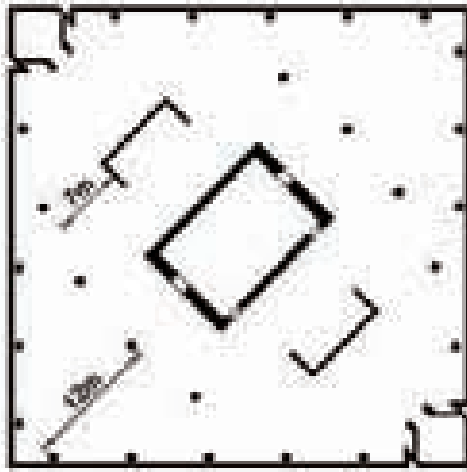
Esquema con la disposición de apoyos y huecos de paso en un forjado tipo.
